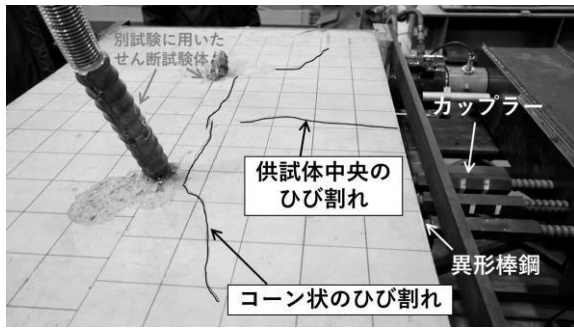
Case-2 供試体上面のコーン状のひび割れ (載荷終了時点)
